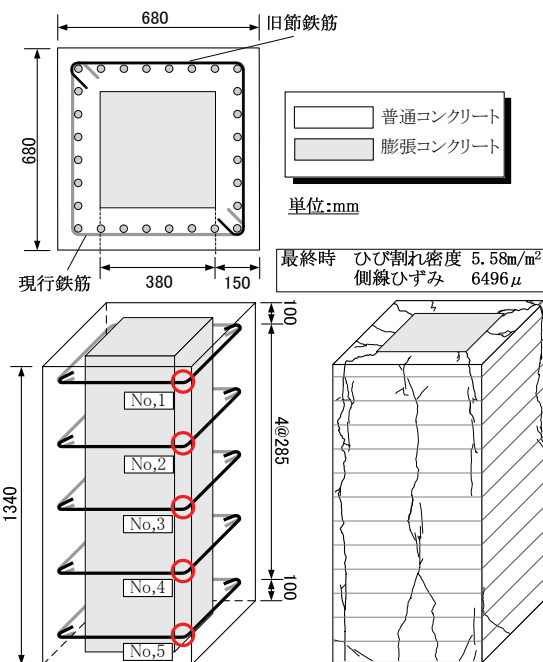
供試体形状、鉄筋 No.、ひび割れ図
